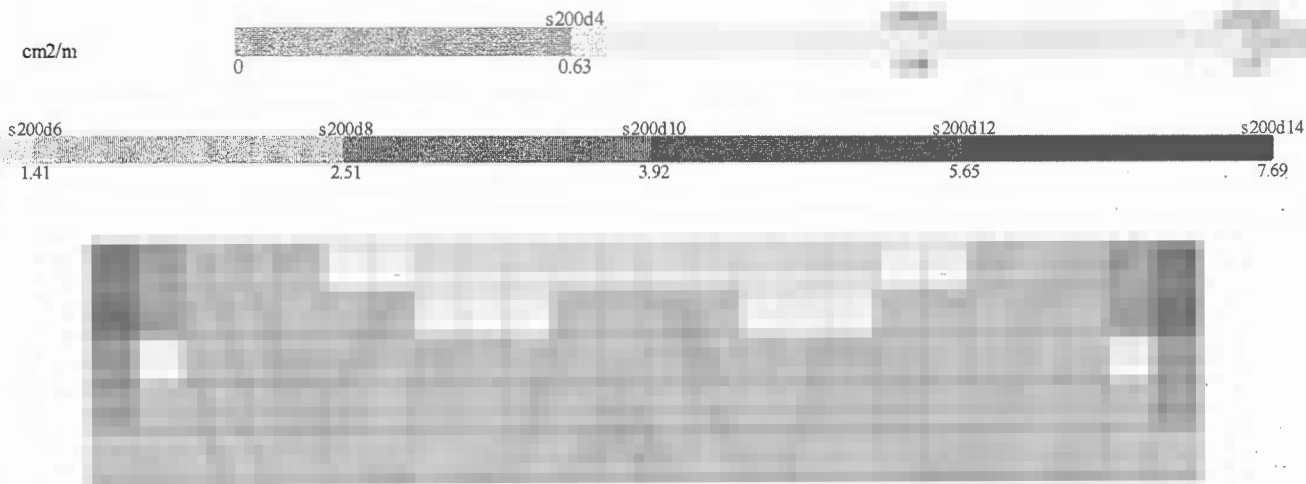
Армирование стены L= 12м вдоль оси X внутренняя грань
